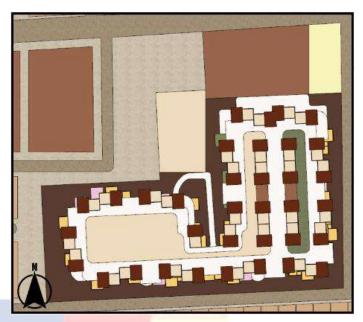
Denah Lantai 4 Gubahan Massa 1
